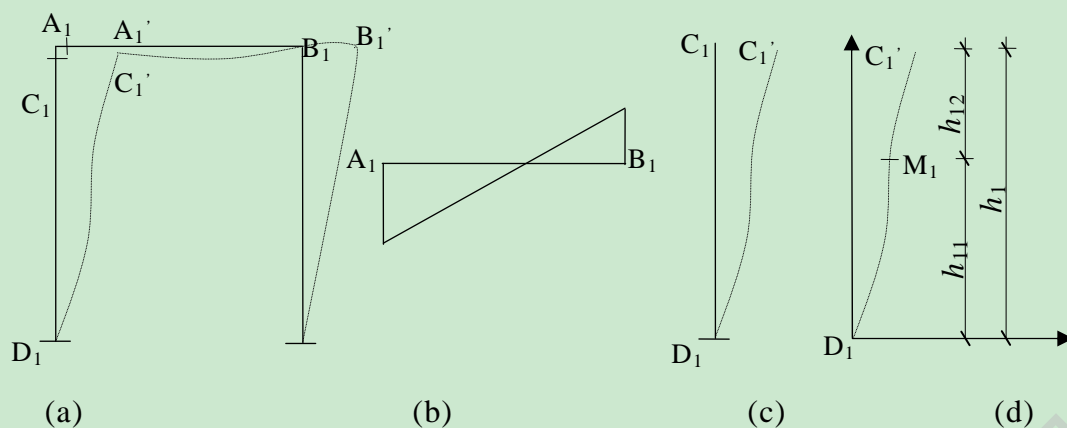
钢管混凝土框架结构底层层间屈服位移的计算
